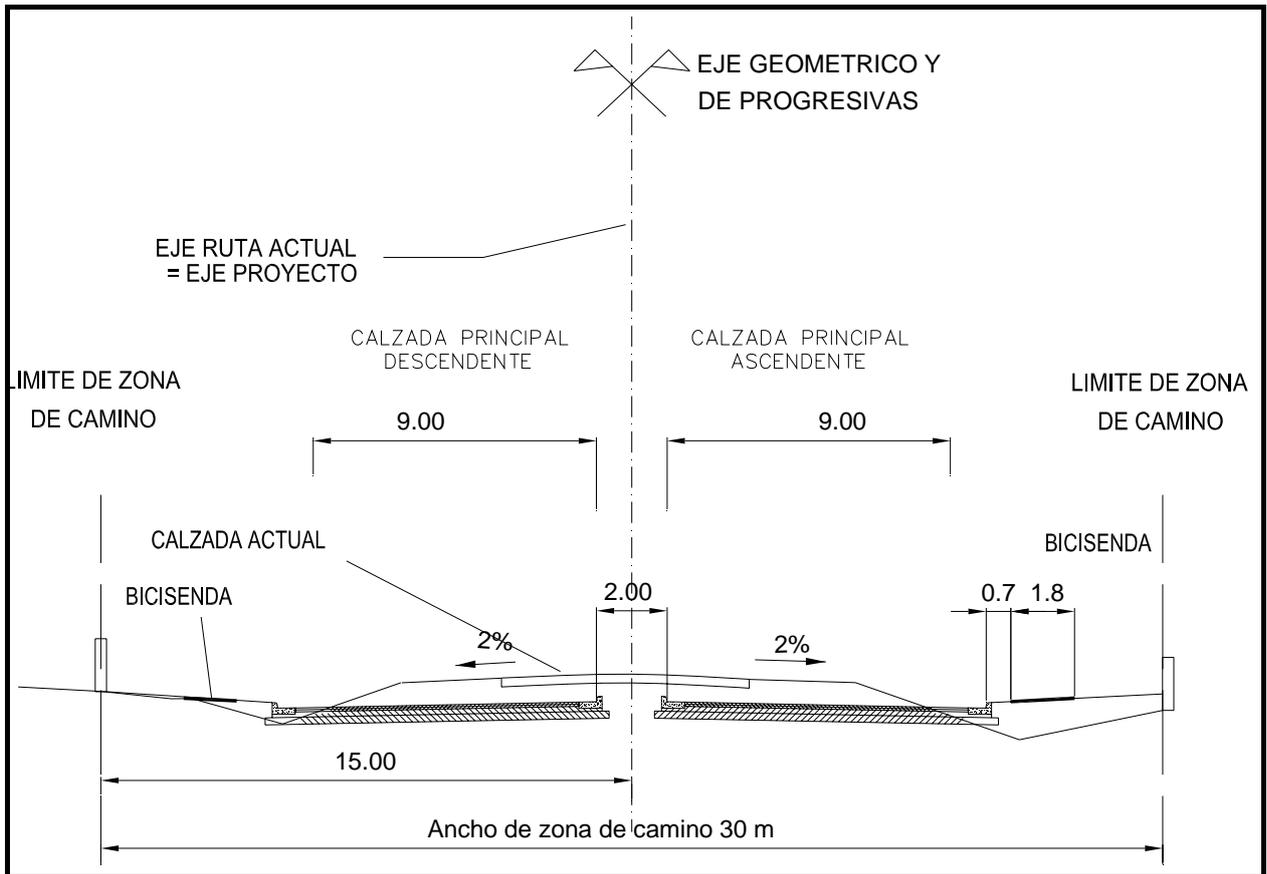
Croquis Tipo 1: perfil de diseño en zona Urbana (Tramo 1, Sección 1)
